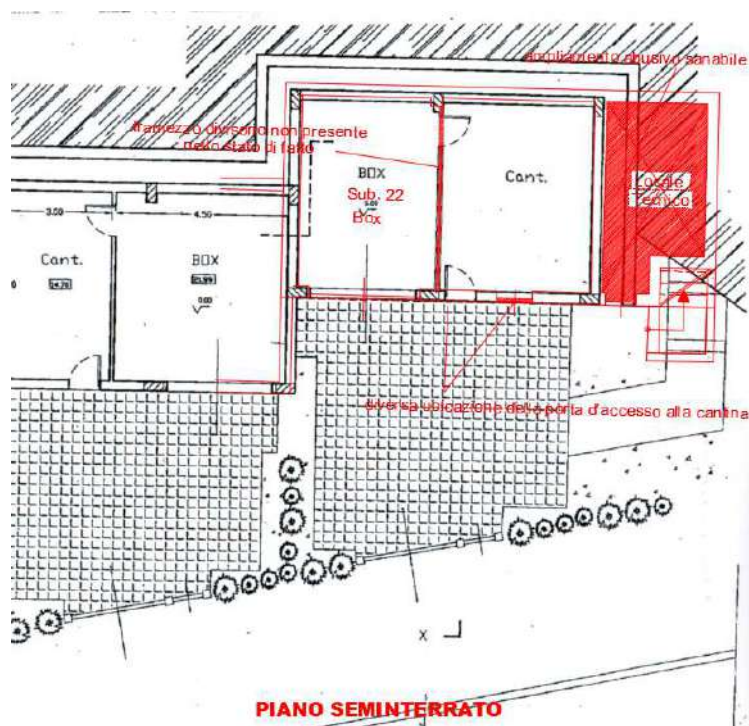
Sovrapposizione della planimetrie di rilievo di piano seminterrato con la corrispettiva planimetria allegata alla Concessione edilizia
